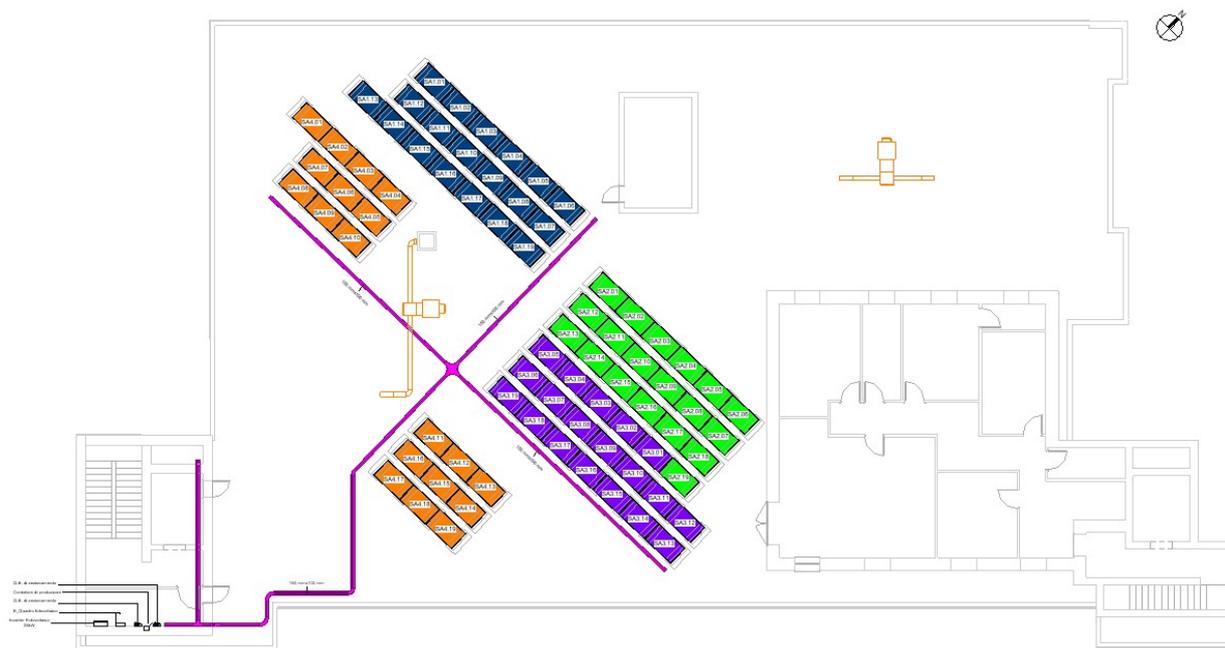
Planimetria copertura dello stato di progetto con layout dell'impianto fotovoltaico
